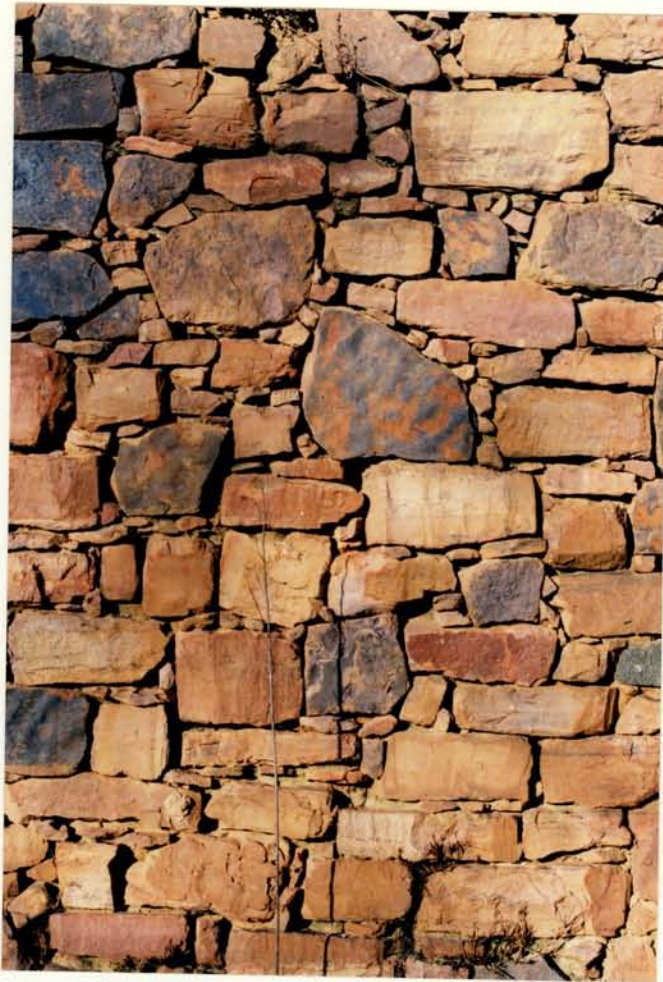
Growwe klipkonstruksie van mure, onafgewerk, gemessel met modderklei en gewig met kleiner klip.
